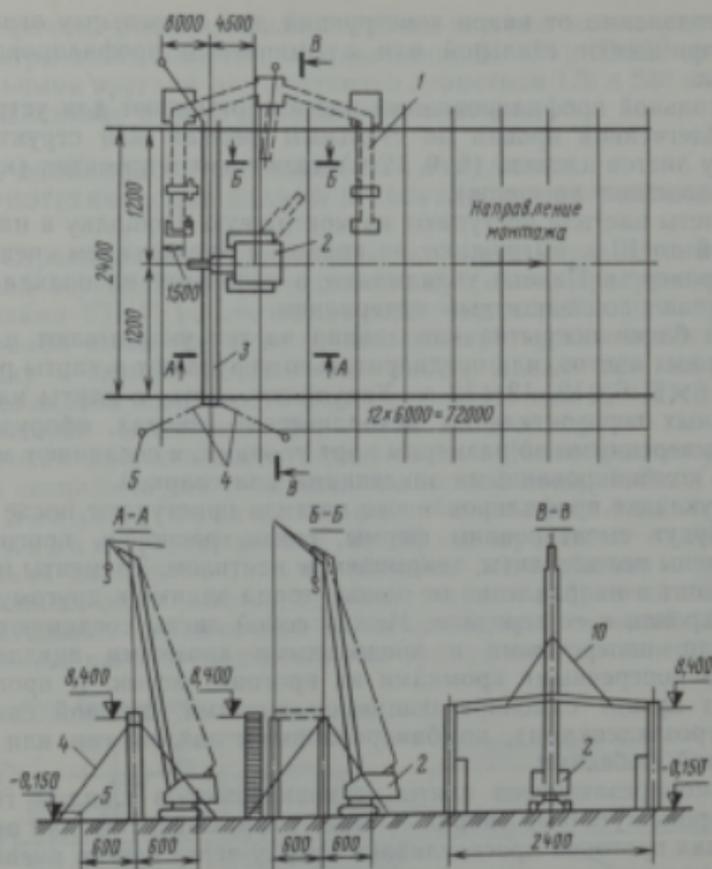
Схема монтажа каркаса здания «Канск»
